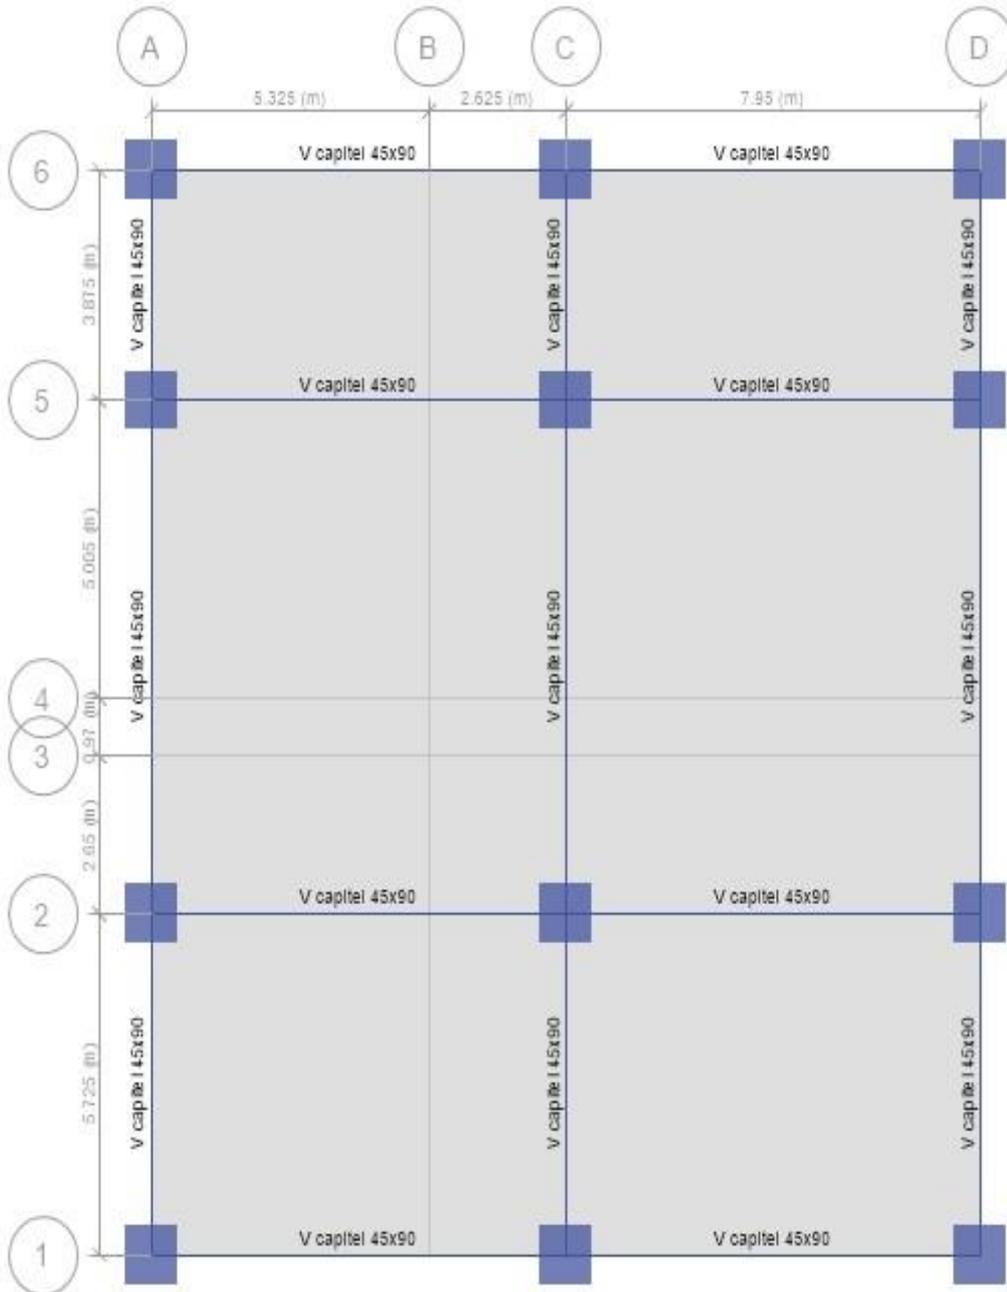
Planta primer nivel (sobre sistema de aislamiento) en ETABS V.16.2
